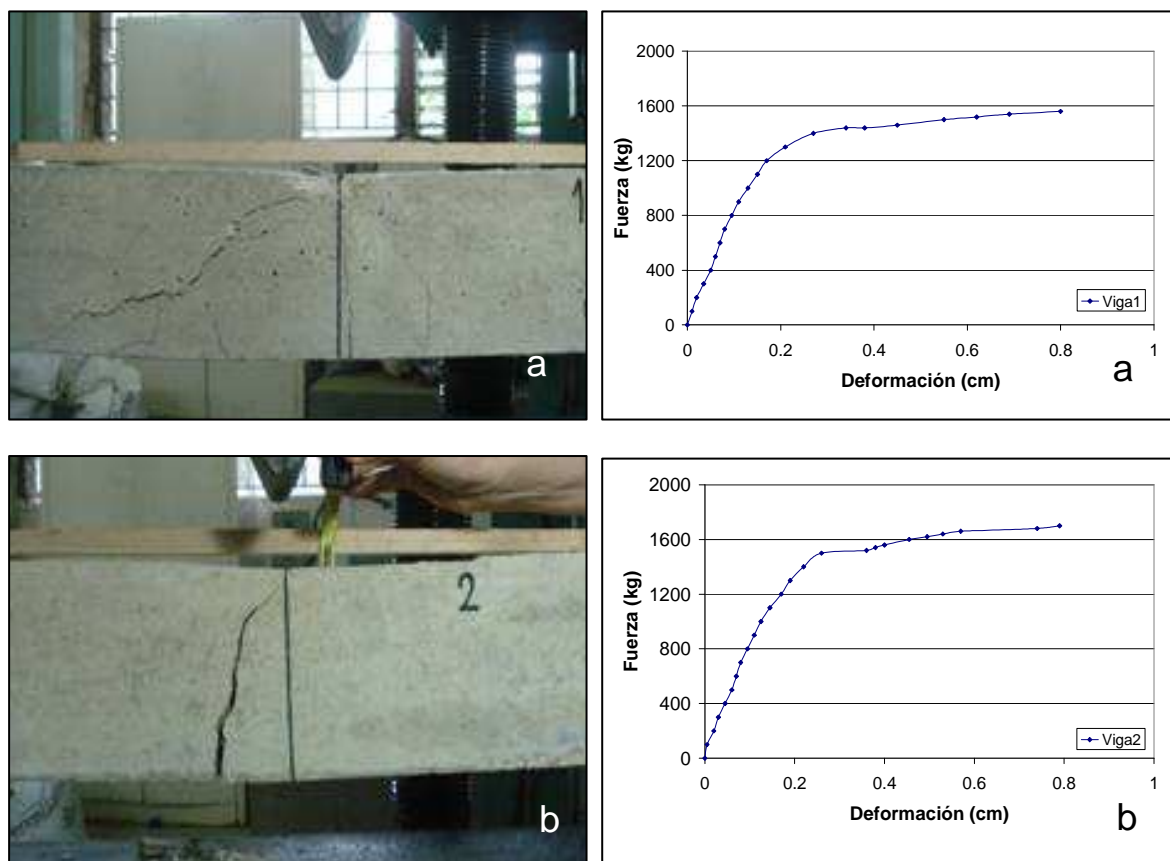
Vigas precargadas por un año, con fisuras por corrosión.
